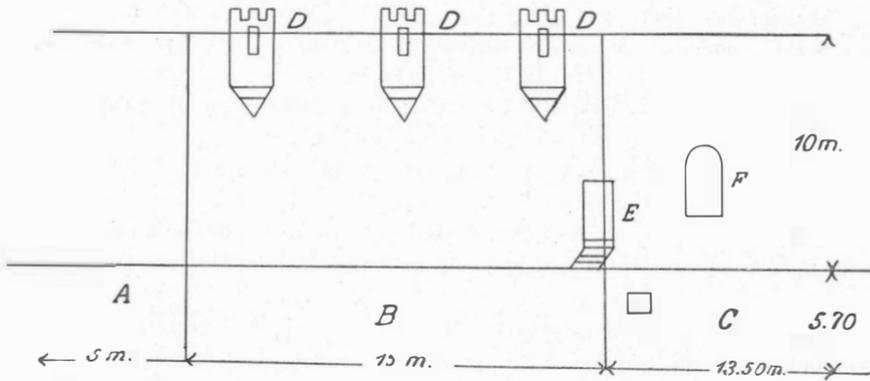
LE MUR TEL QU'IL EXISTAIT EN 1909 AVANT SA DESTRUCTION PAR LA VILLE.
